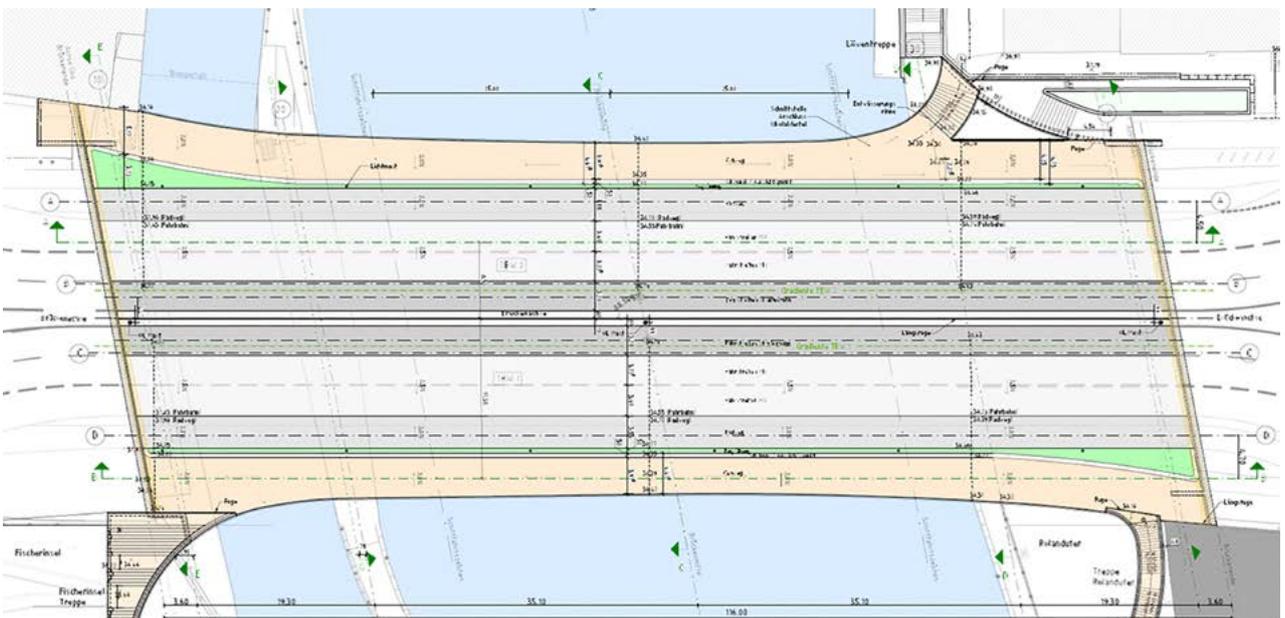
Grundriss der neuen Mühlendammbücke – Entwurfsplanung
